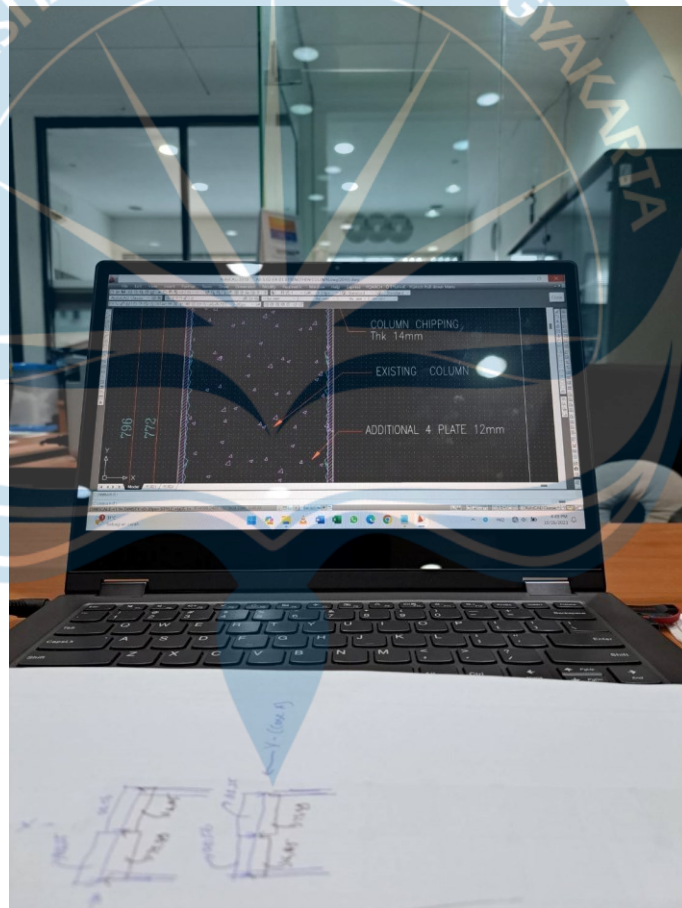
Alternatif Desain Balok Voute (Kantilever)
